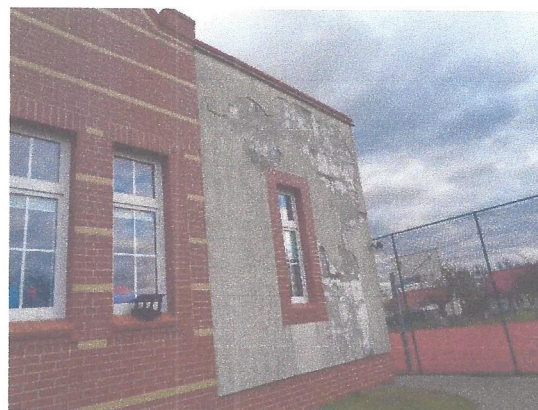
Ściana szczytowa, wieżyczka na dachu.
